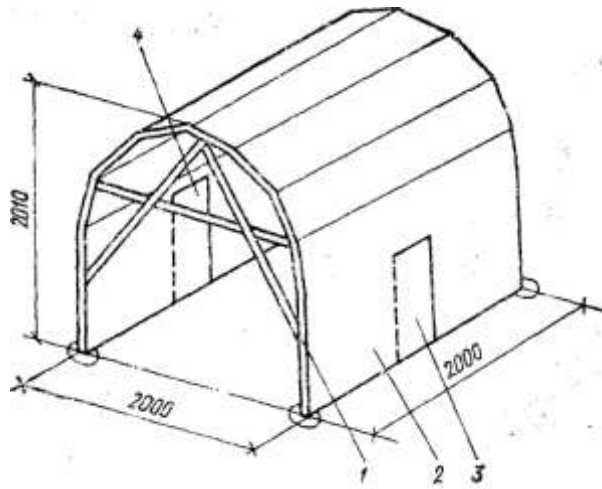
Будка для укрытия места сварки 1 — каркас; 2 — брезент; 3 и 4 — окна для вентиляции
